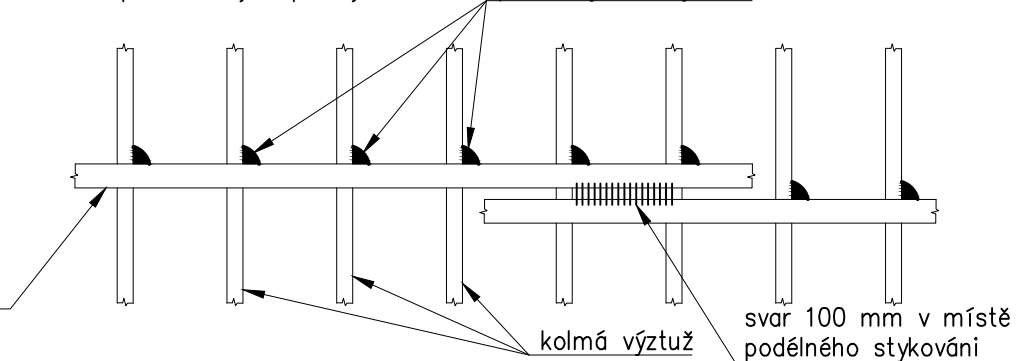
PODÉLNĚHO PROVAŘENÍ VÝZTUŽE
